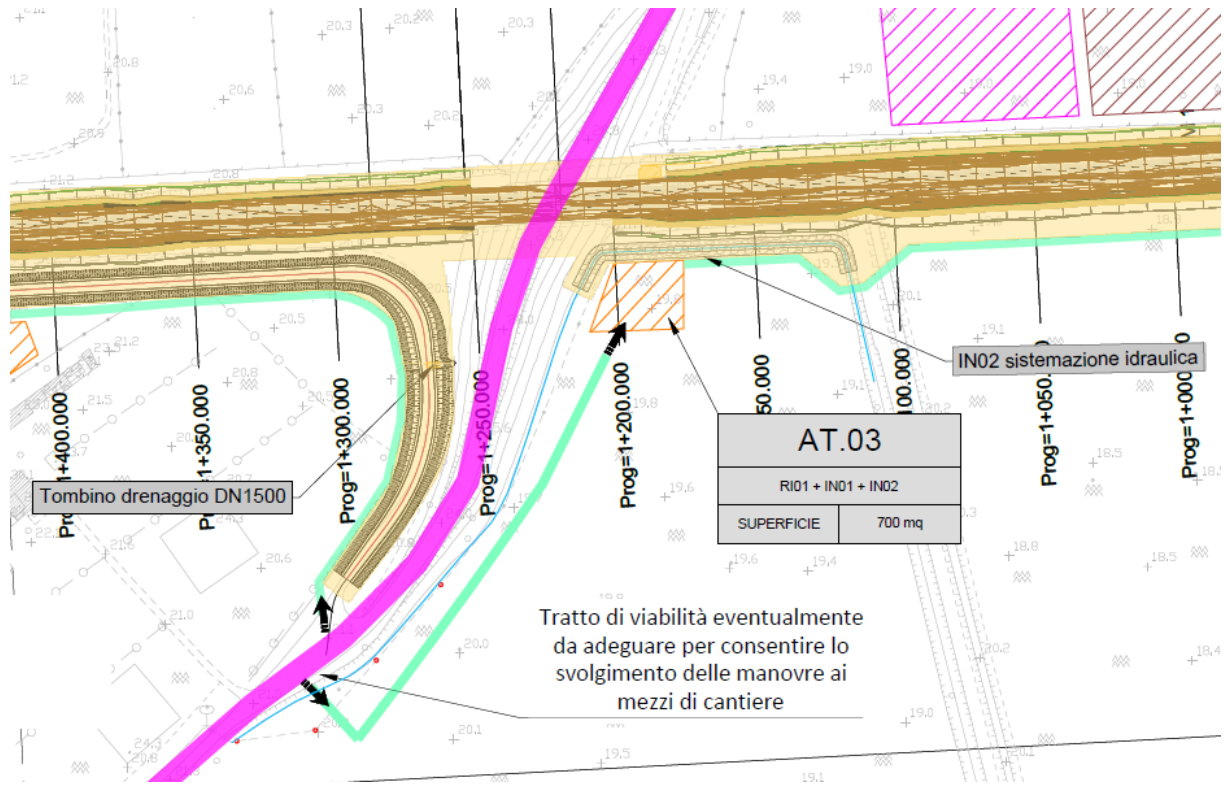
Vista in pianta dell'area di cantiere AT.03
